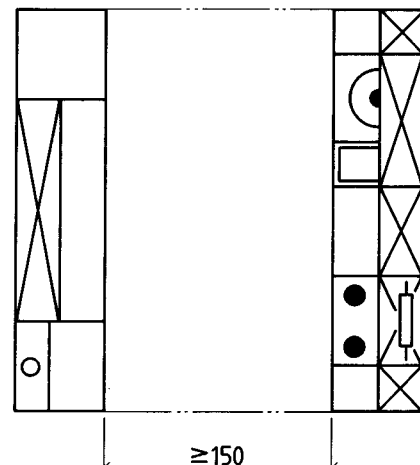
Bewegungsflächen in einer zweizeiligen Küche
